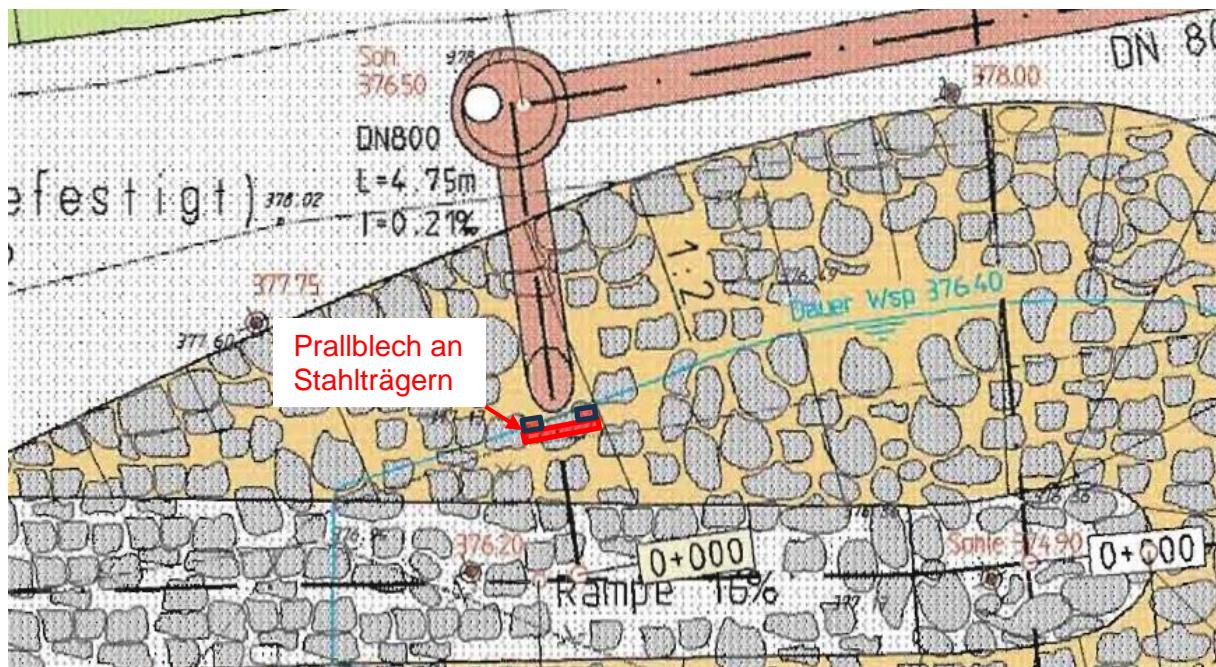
Skizze Lageplan Prallblech vor Zulaufleitung
